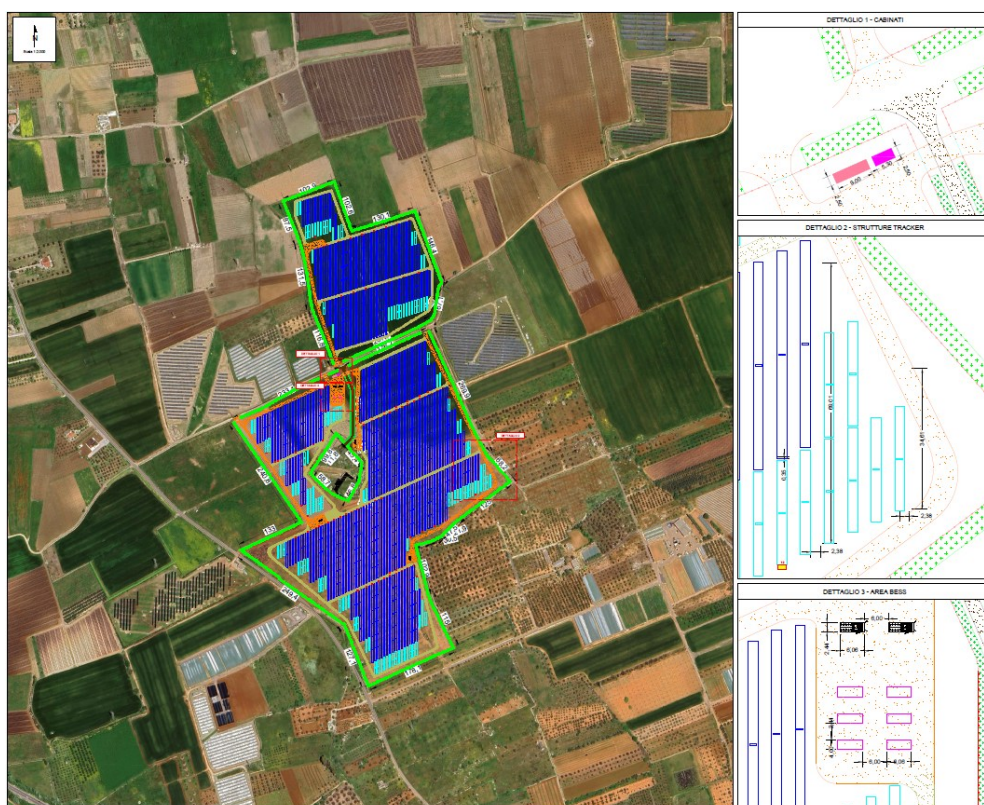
Stralcio del layout. Elaborato. Tav.20 - Opere di mitigazione
